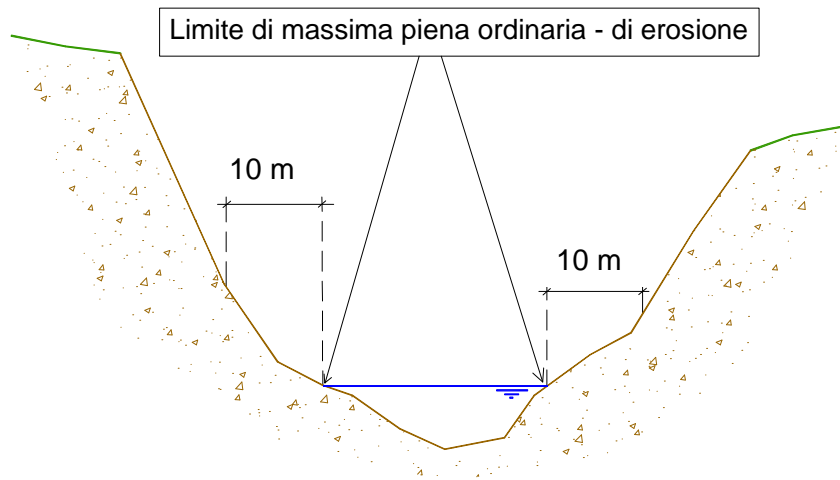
Schemi grafici per la definizione delle fasce di rispetto
